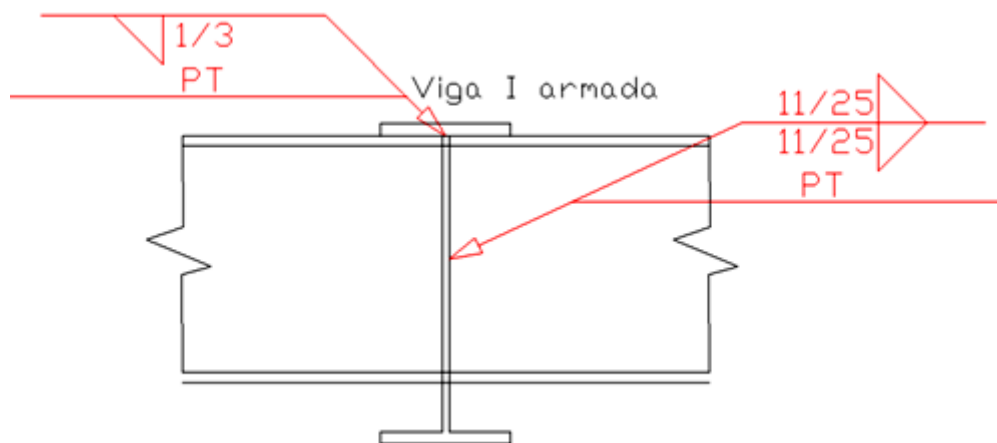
UNION DE LA VIGA UPN350 A LA VIGA I
